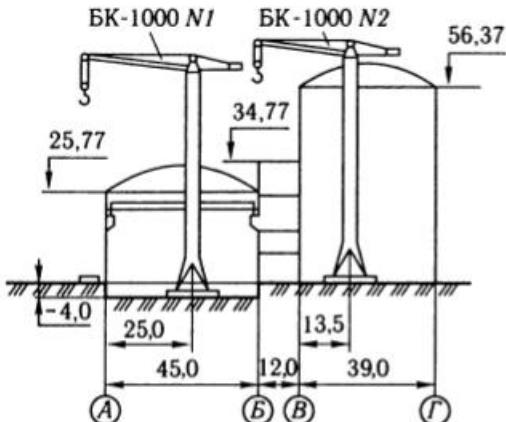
Схема установлення монтажних кранів на ТЕЦ
